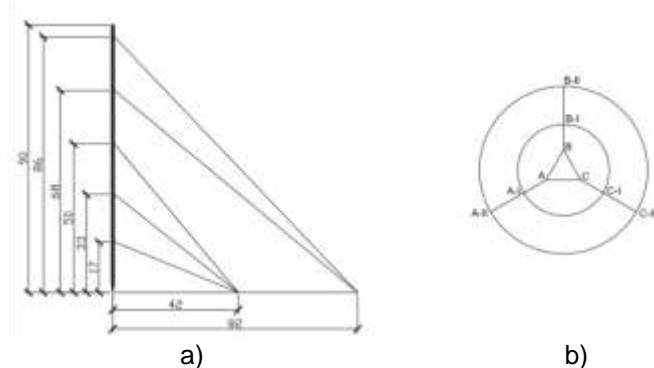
a) Elevación de la torre MAR-300 b) Planta de la estructura del modelo MAR-300
